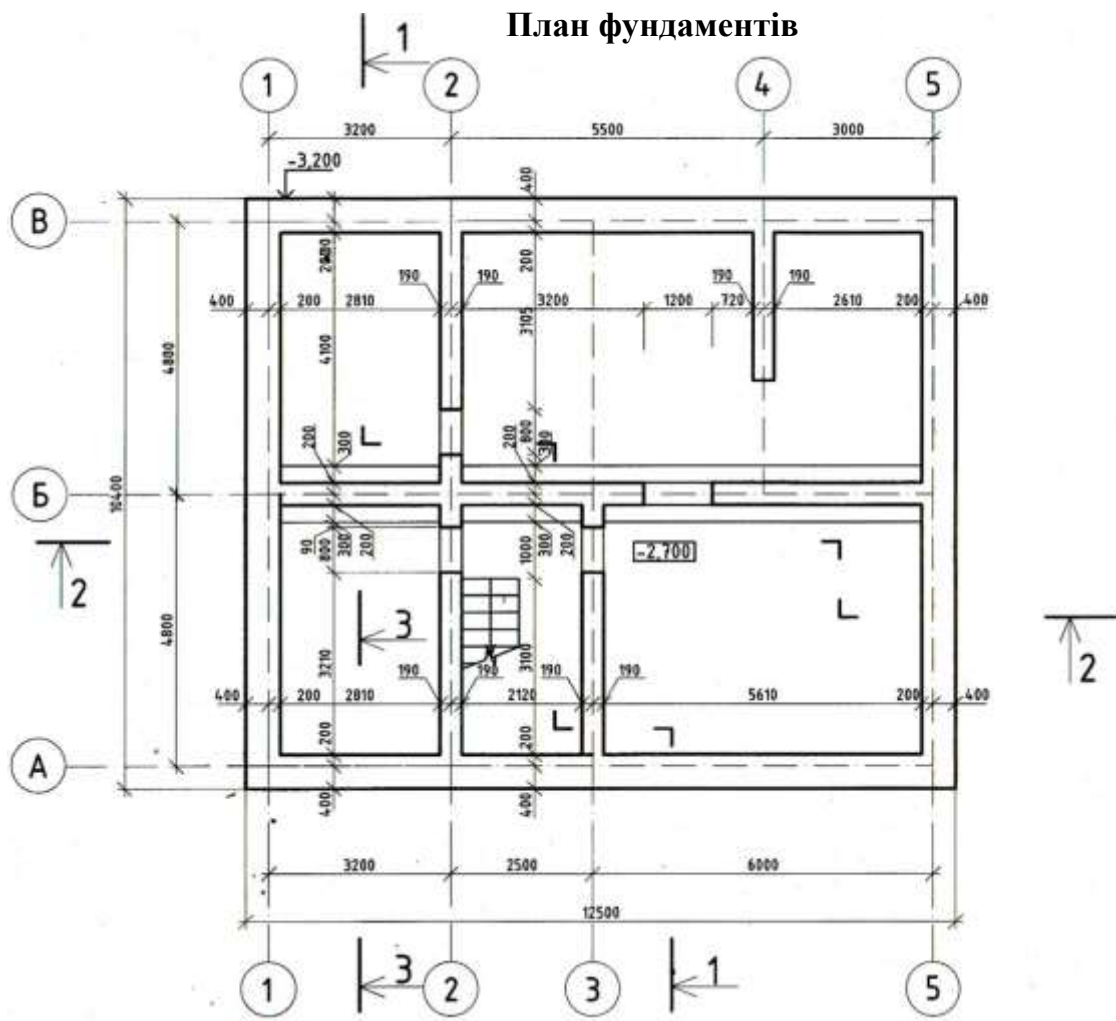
План фундаментів і приміщень підвалу одноквартирного житлового будинку
